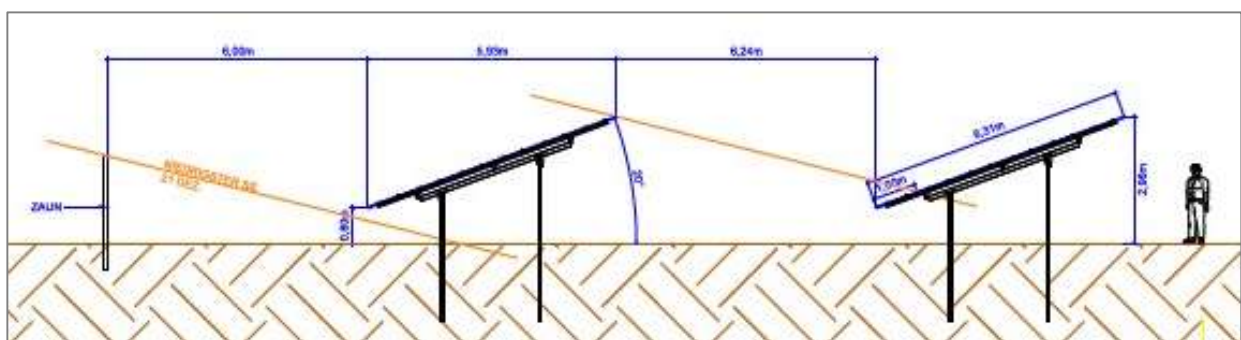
Detailansicht der geplanten Modulaufstellung (Solibra GmbH, 18.03.2021)
